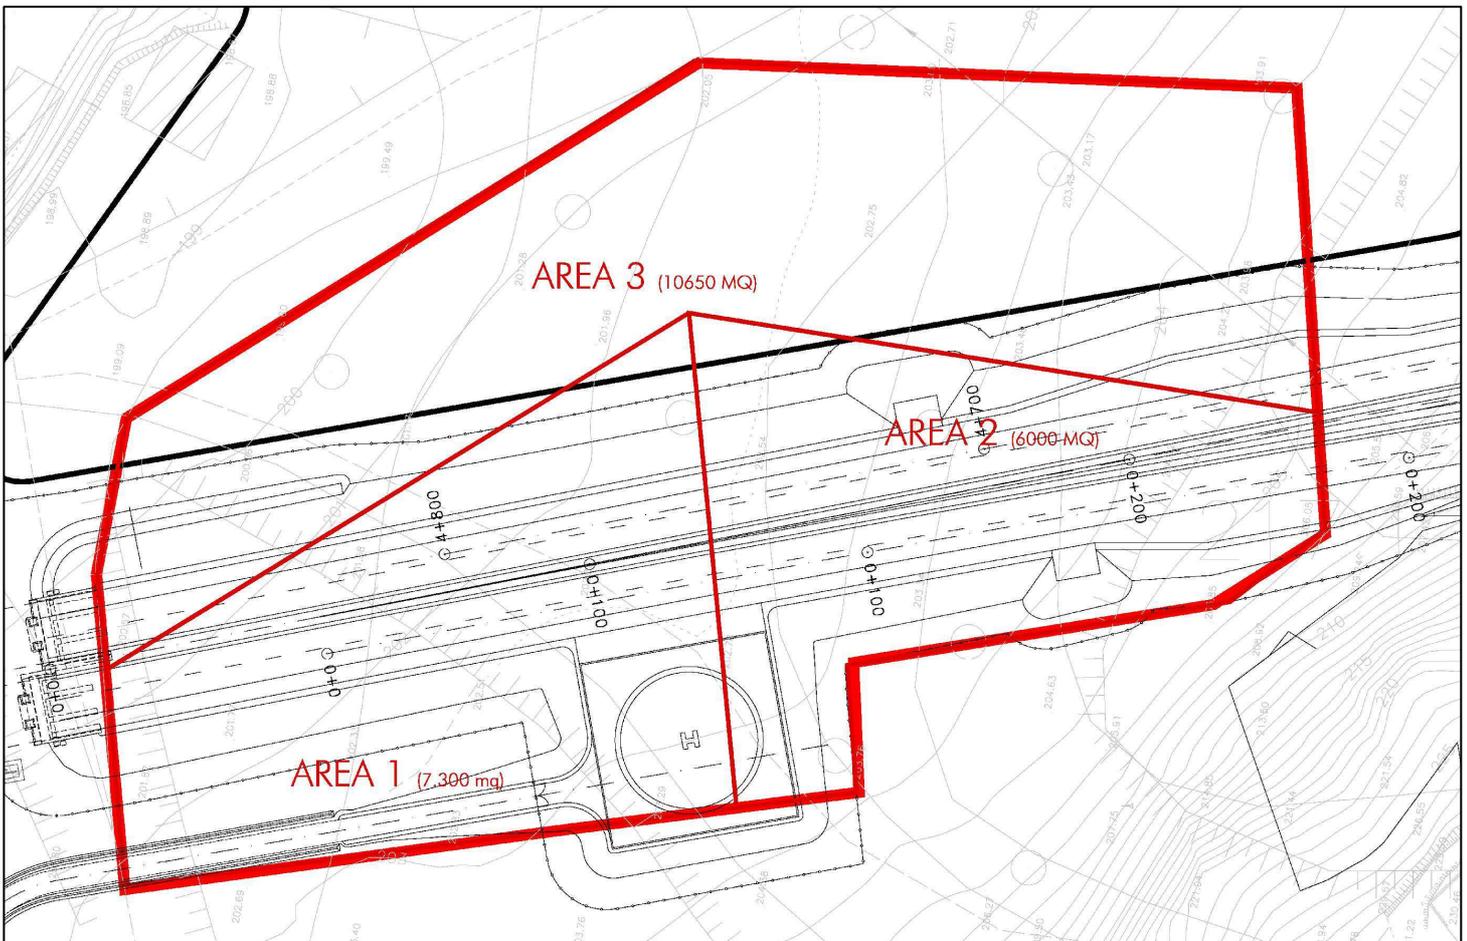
Indicazione della suddivisione in Aree su stralcio della planimetria di progetto
